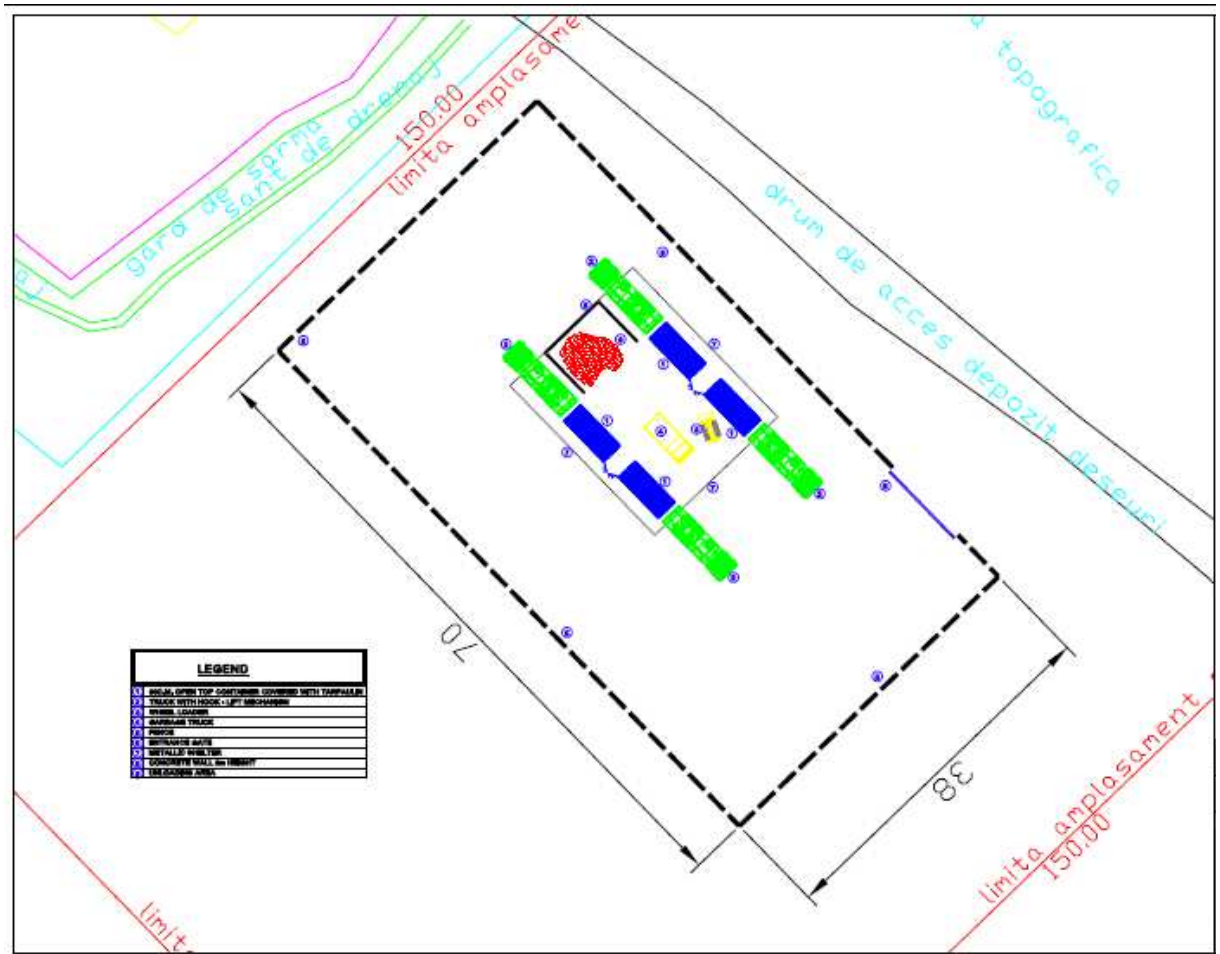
a) Plan general platformă de stocare temporară Ștei
